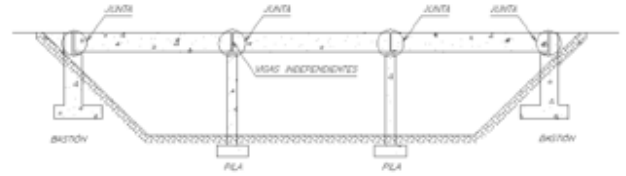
Superestructura tipo viga simple. Se notan 3 vigas apoyadas.
